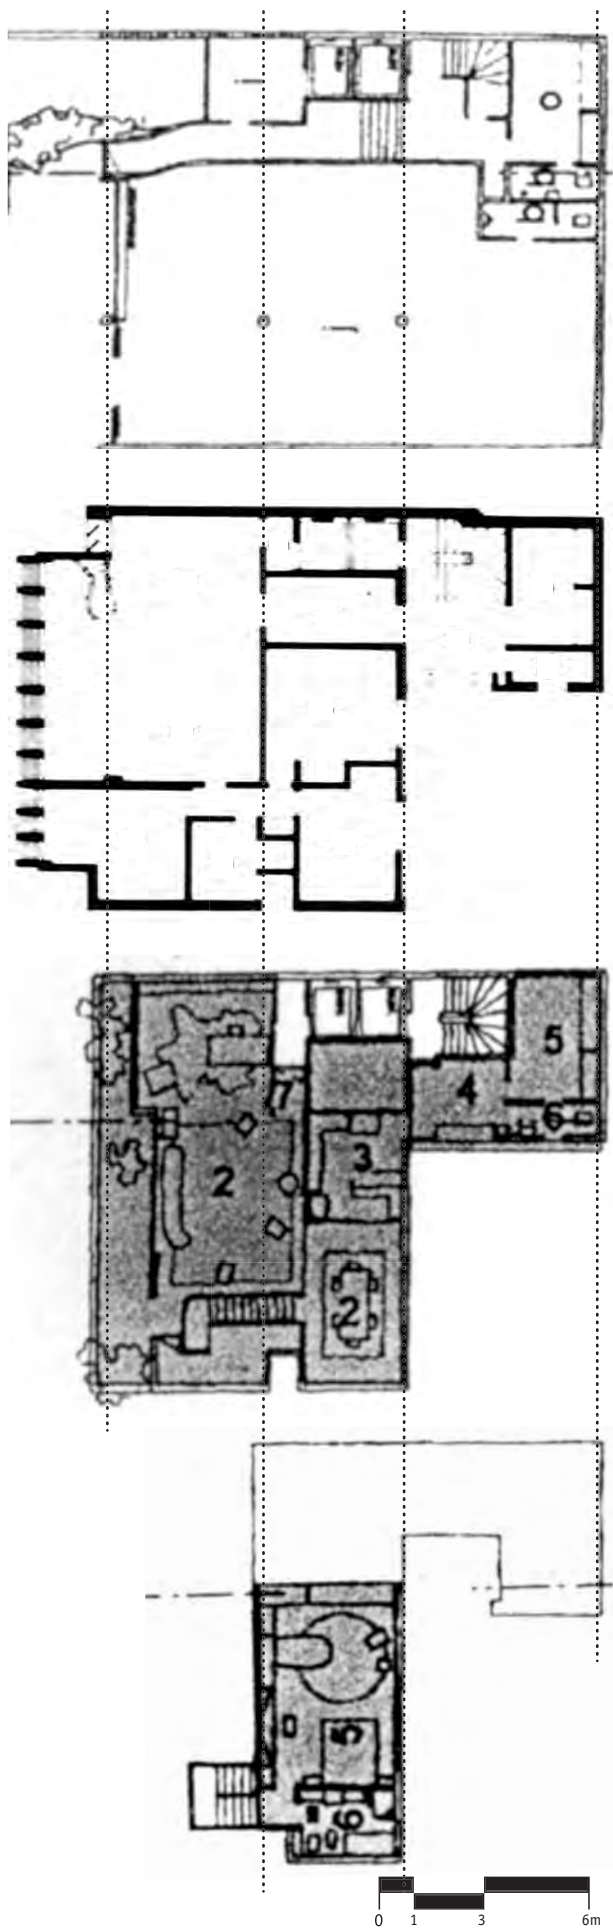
MMM Roberto: Edifício MMM Roberto, Rio de Janeiro, 1945. Plantas Baixas. [DREBES, 2003]
